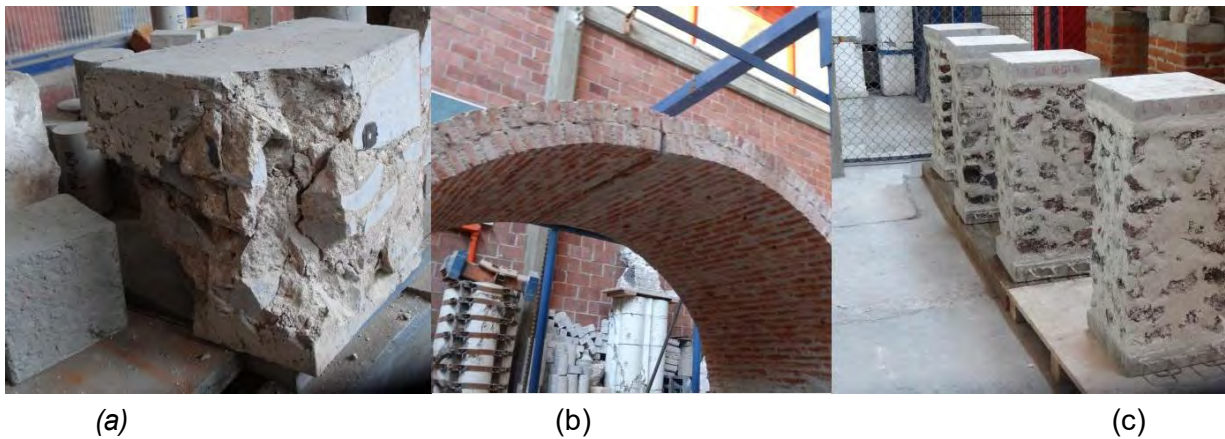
Objetos de aplicación potencial de la nueva técnica: (a) bloque de concreto dañado por sobrecarga, (b) arco de ladrillo con una grieta abierta y (c) las columnas de piedra tezontle (Fotografías).
